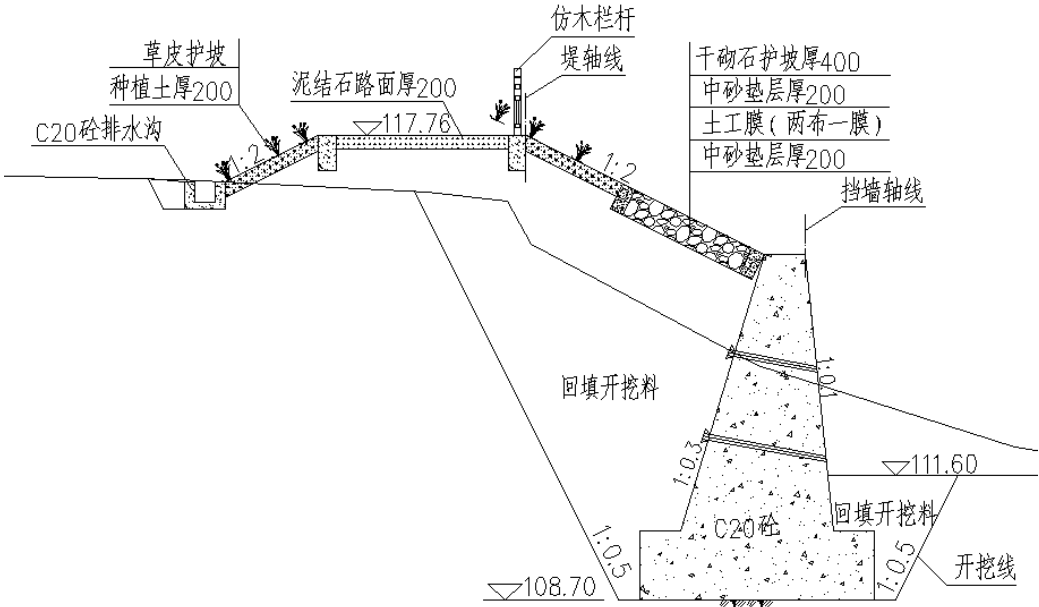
新建重力式 C20 砼堤横断面布置示意图
